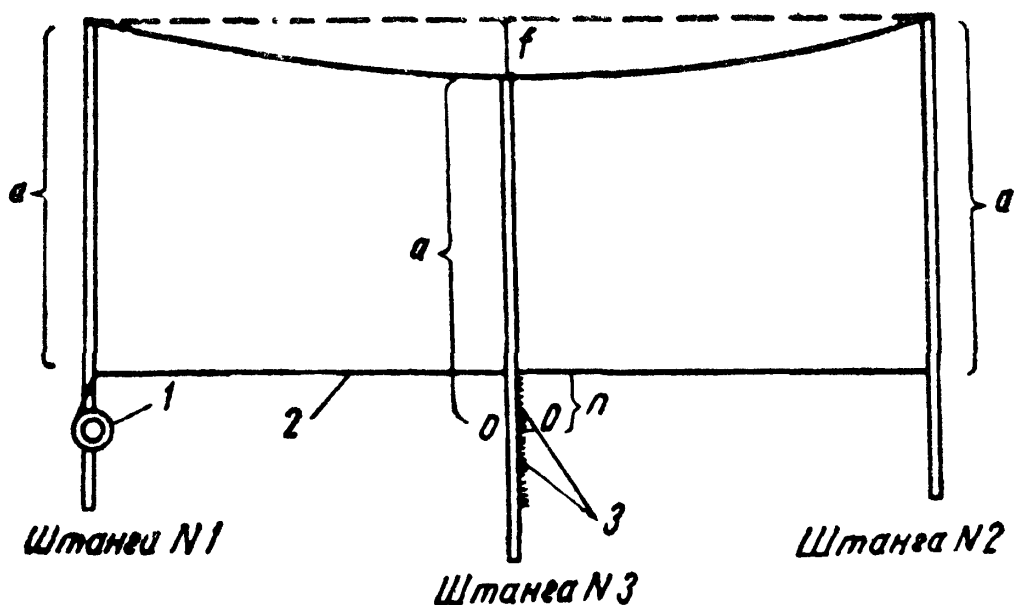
Примеры определения прогиба плит перекрытий прибором из тарировочных стоек
